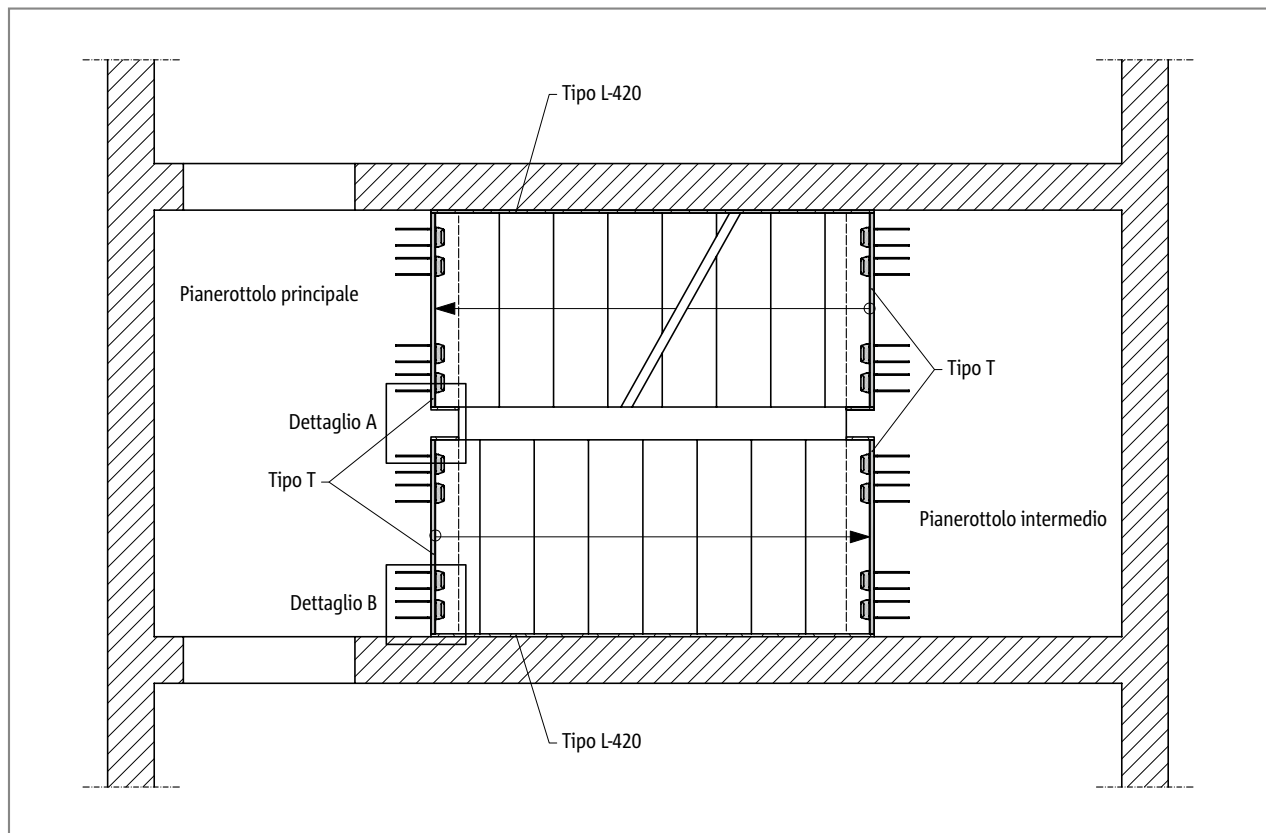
Schöck Tronsole® tipo T, disposizione dell'elemento in pianta
